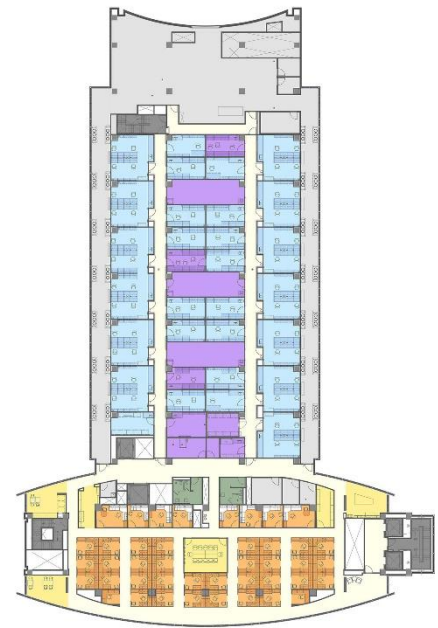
План типового поверху будівлі 23 з інтегрованими лабораторіями BSL-2
